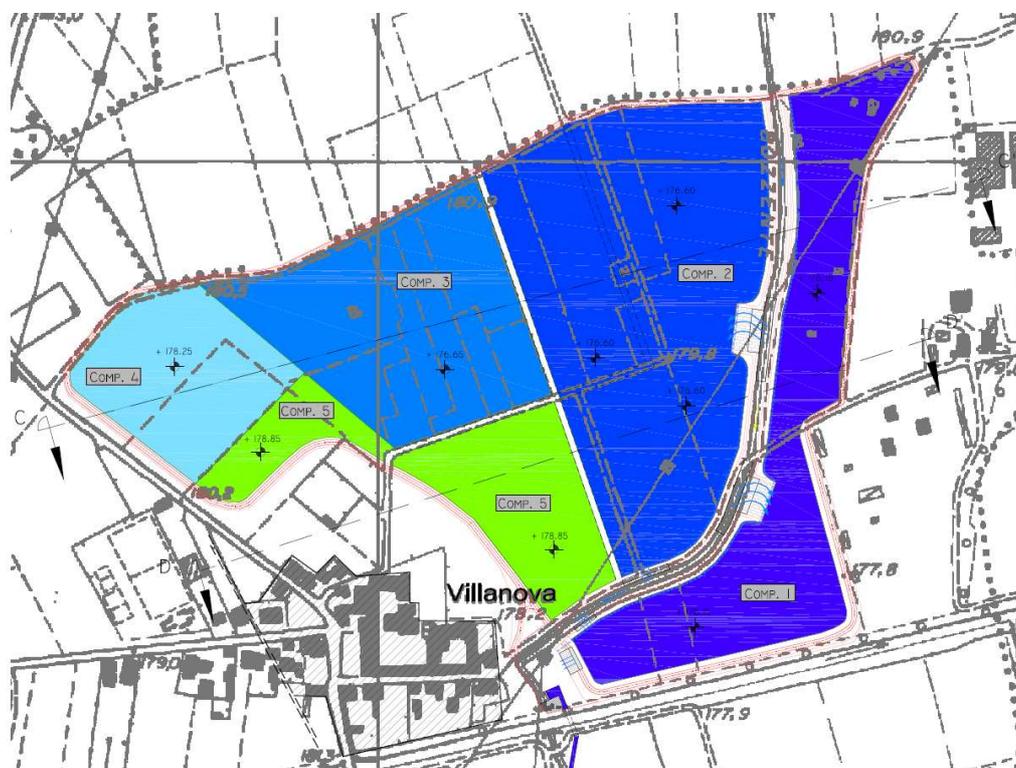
Planimetria della cassa (Ipotesi 2C)
